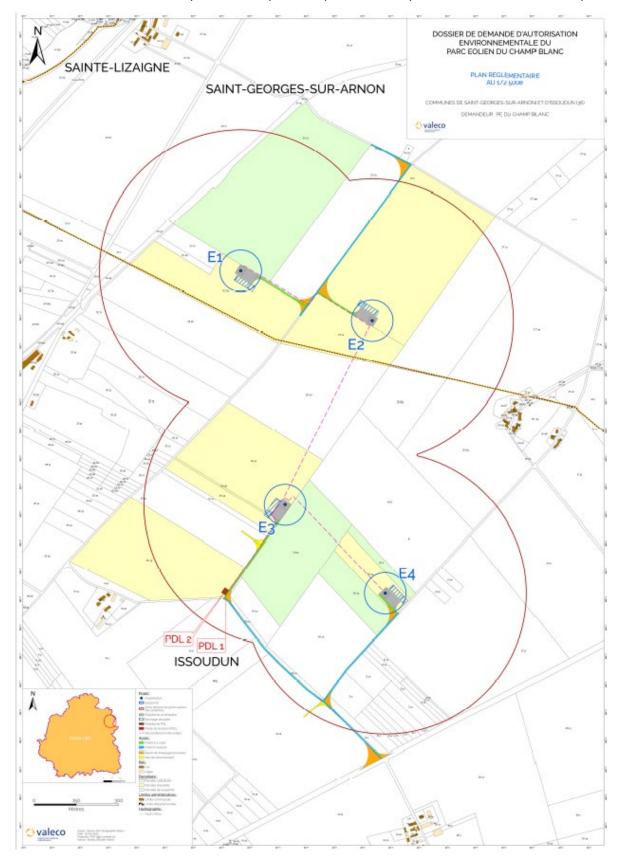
Plan règlementaire de l'implantation retenue (disponible en pièce 10)
